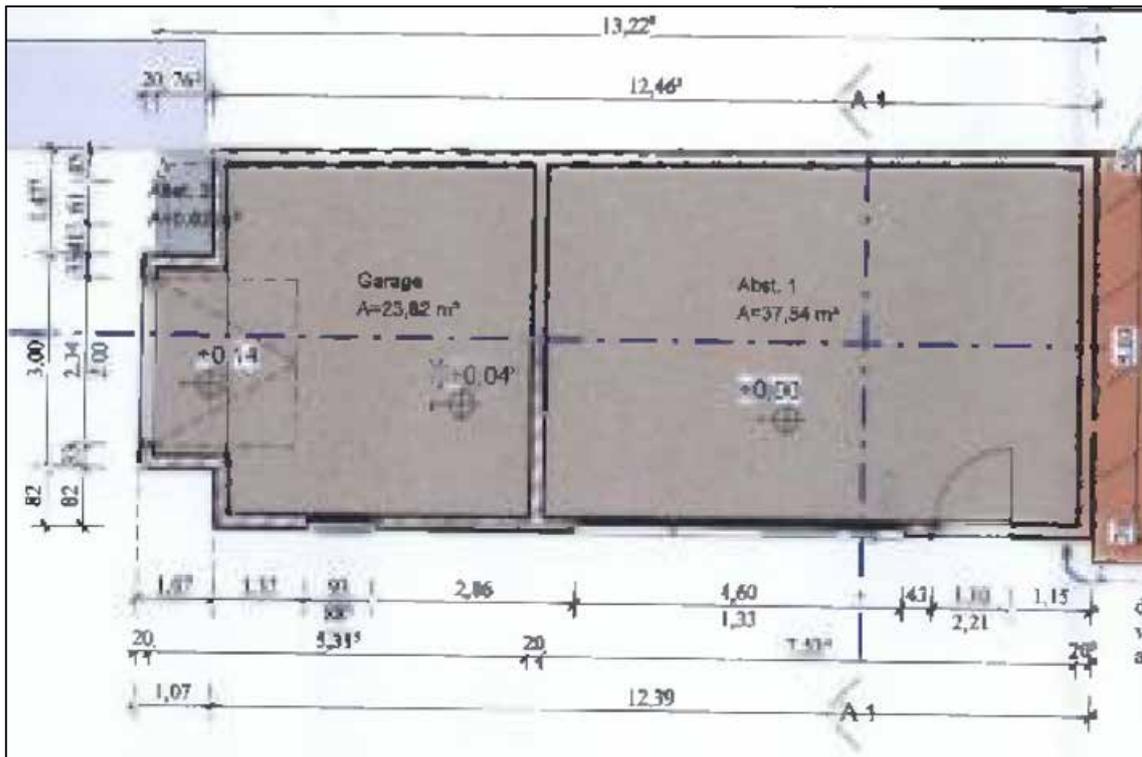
Erdgeschoss-Grundriss vom Lagerraum mit Garage ohne Maßstab aus den Bauakten der Stadt Hamm © Stadt Hamm
